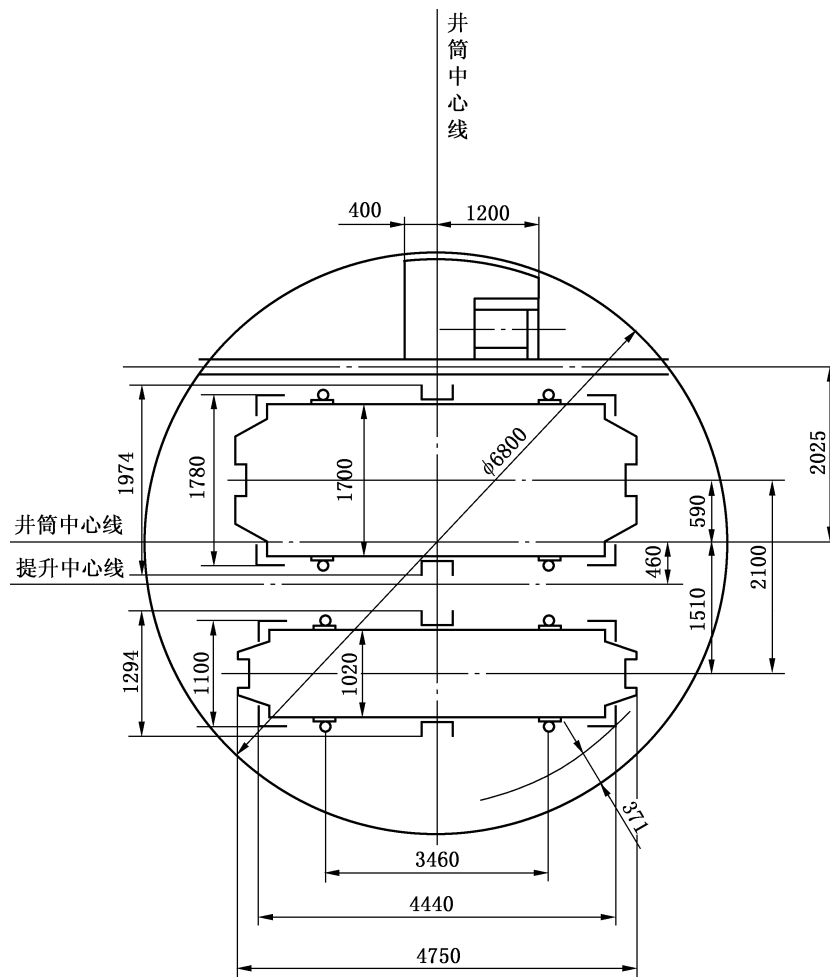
1 t 一层二车或二层四车窄、宽罐笼绳罐道四角布置井筒断面布置图
